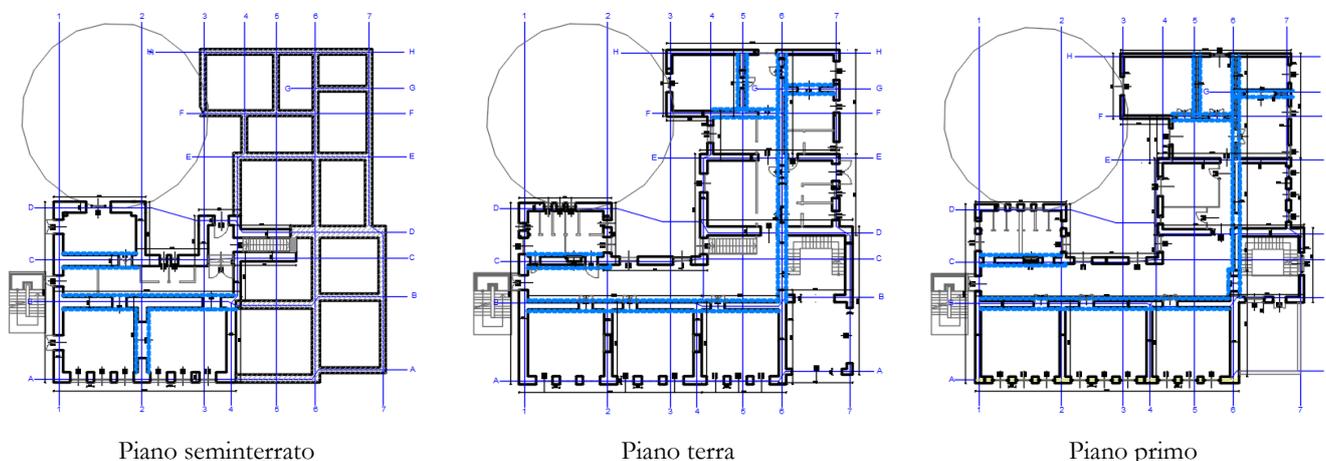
INDIVIDUAZIONE ELEMENTI DA RINFORZARE CON INTONACO ARMATO
